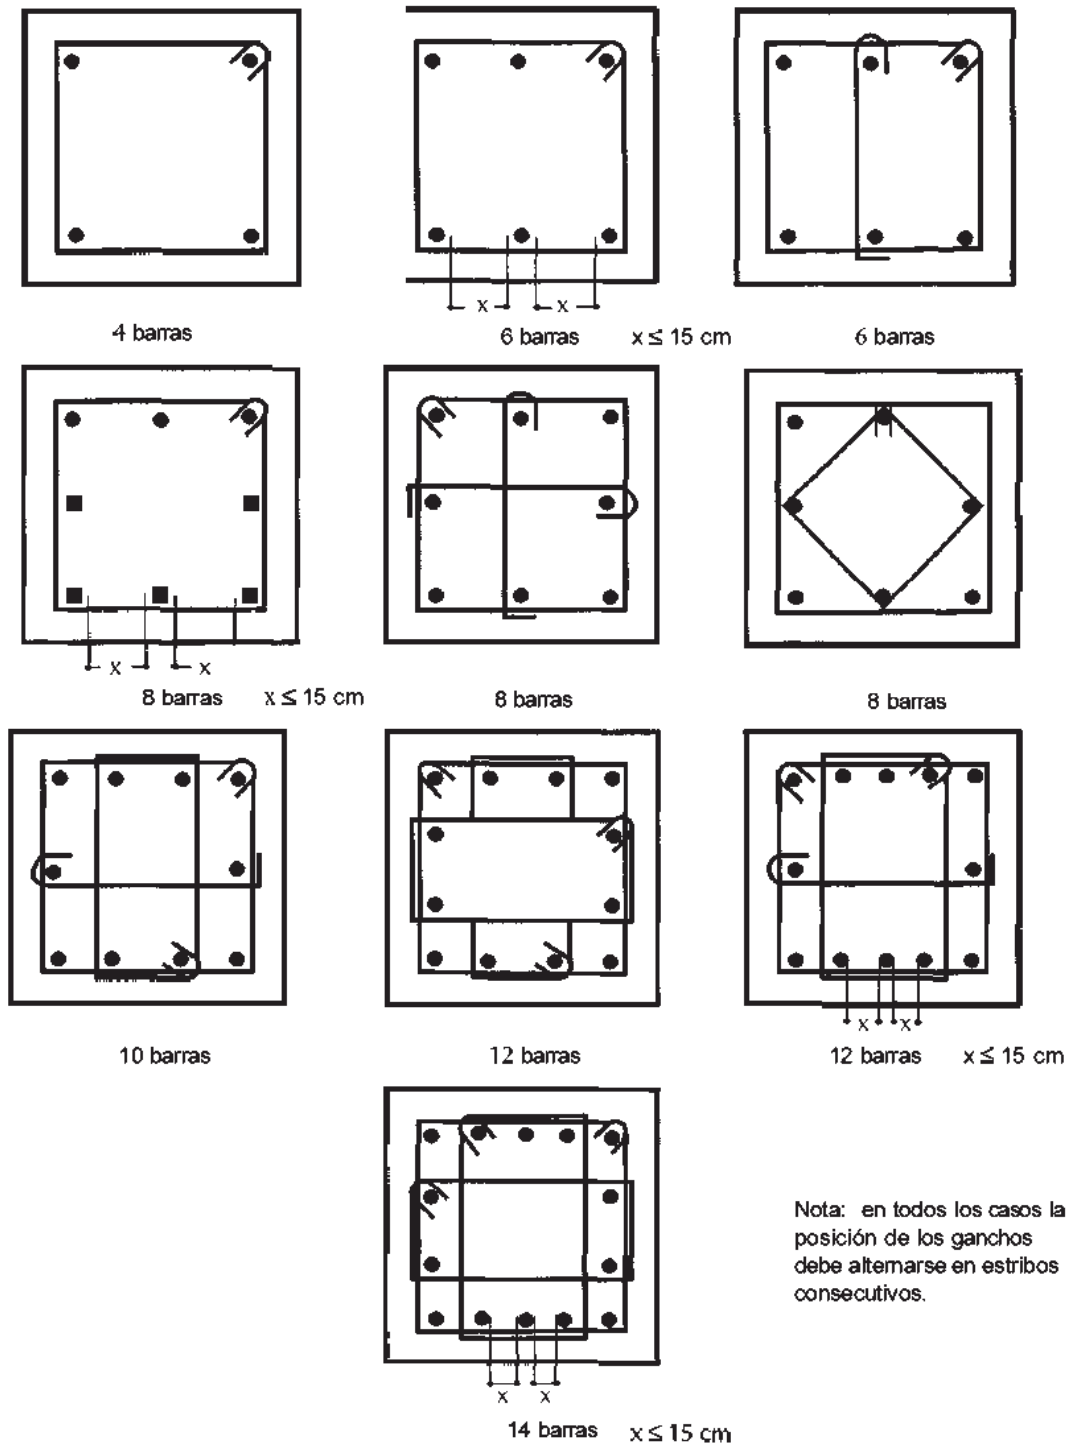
Formas de armado comunes en columnas (Gonzales et al, 2005)
